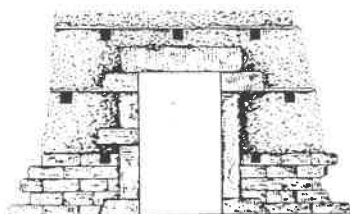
PUERTA CON MARCO EN MAMPOSTERIA - DINTEL DE MADERA
